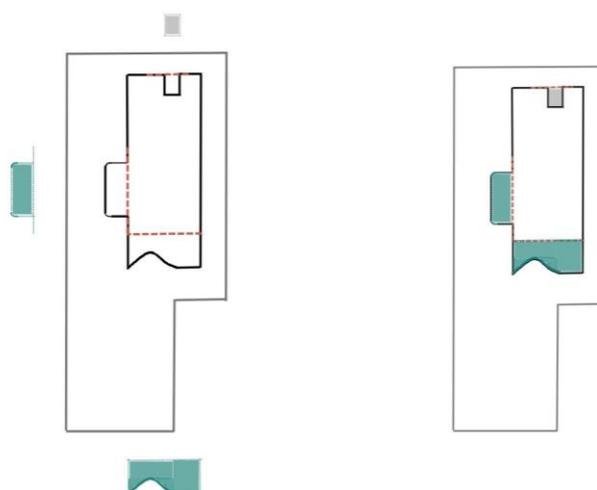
Edifício Residencial das Ubaias - implantação - subtrações em cinza e adições em azul na planta.
